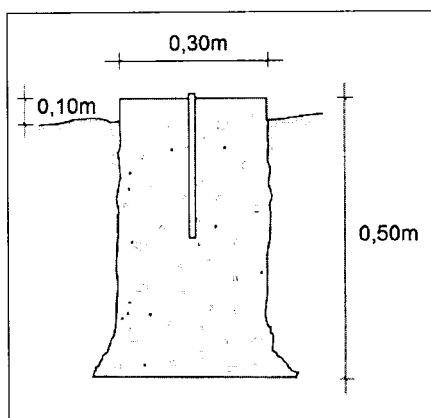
Monolito de Hormigón, vista en elevación y sus dimensiones
